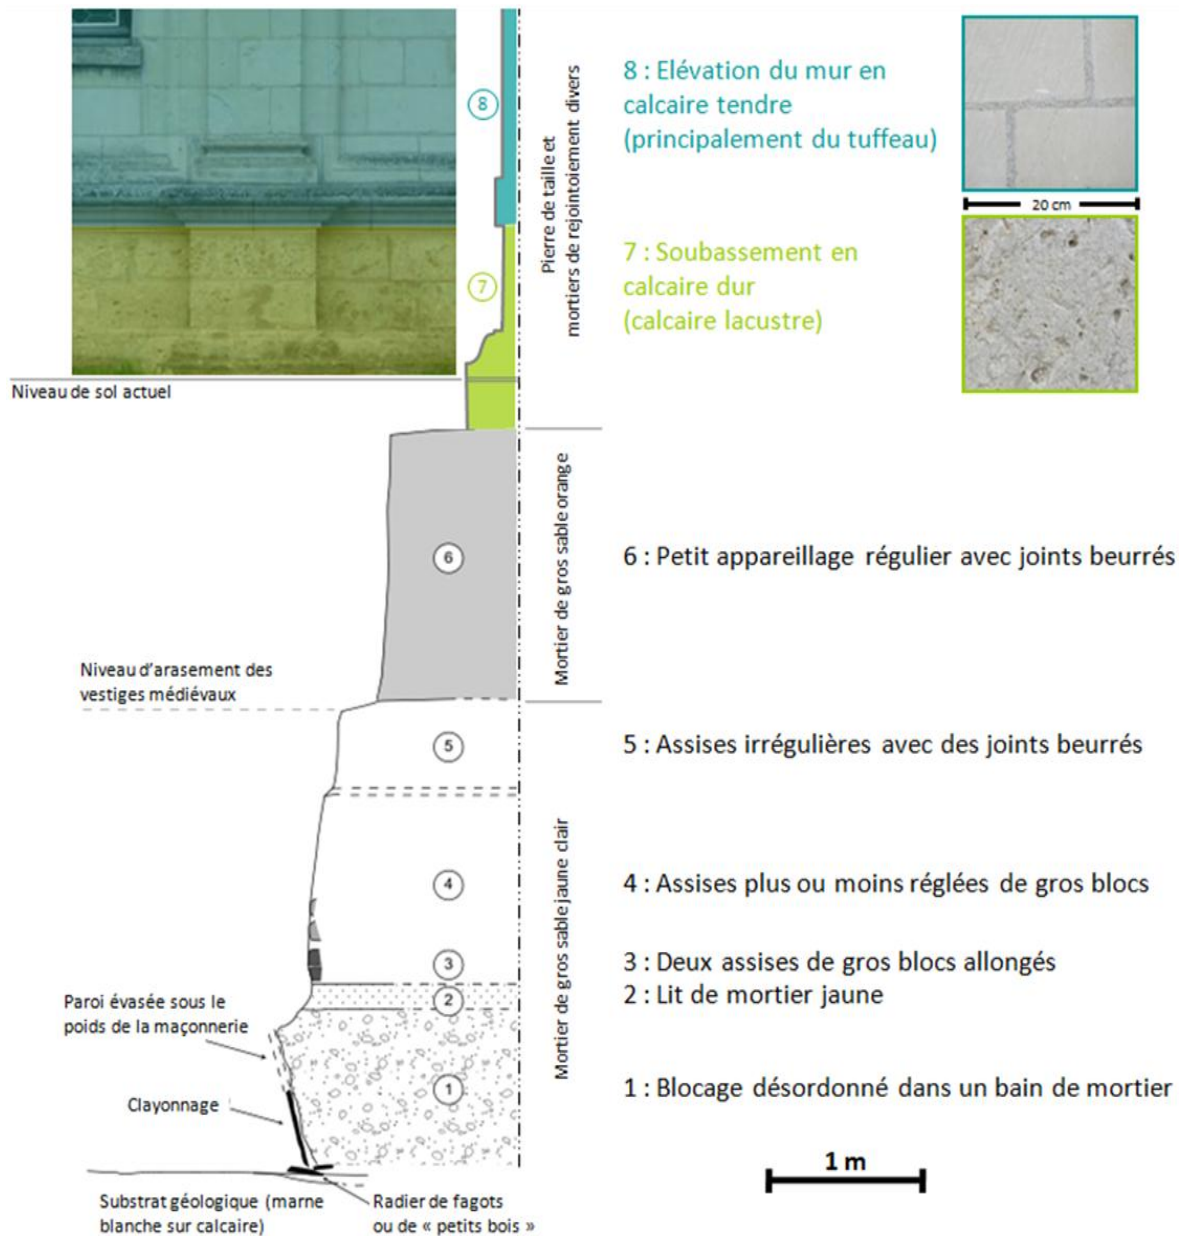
PROFIL DES FONDATIONS ET DE L'ELEVATION DE LA TOUR DU CHAUDRON – COUPE REALISEE AU NIVEAU DE LA COUR (ADAPTATION D'APRES BRYANT *ET AL.*, 2007)
